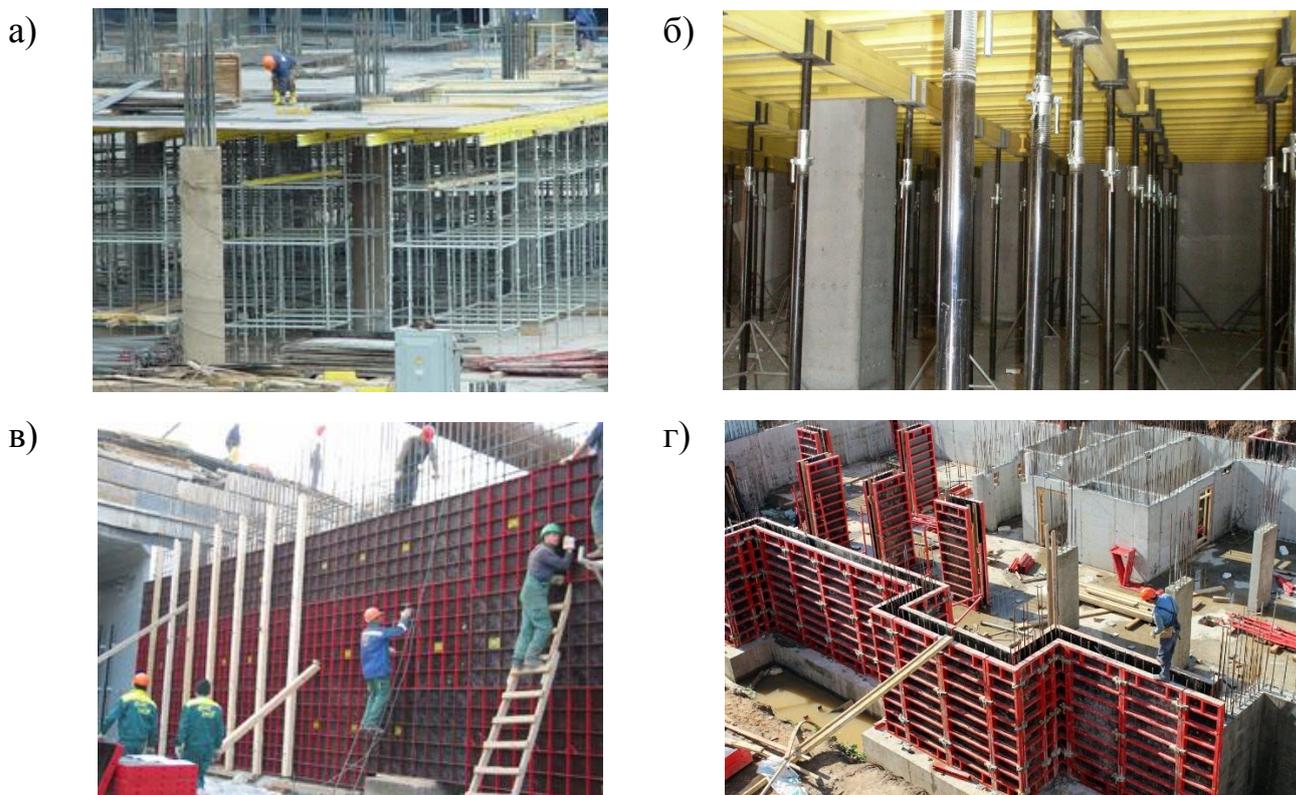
Опалубочные системы для строительства зданий из монолитного железобетона: а) – рамная опалубочная система для перекрытия; б) - балочно-стоечная система для перекрытия; в) - мелкощитовая опалубка стен; г) крупнощитовая опалубка стен
